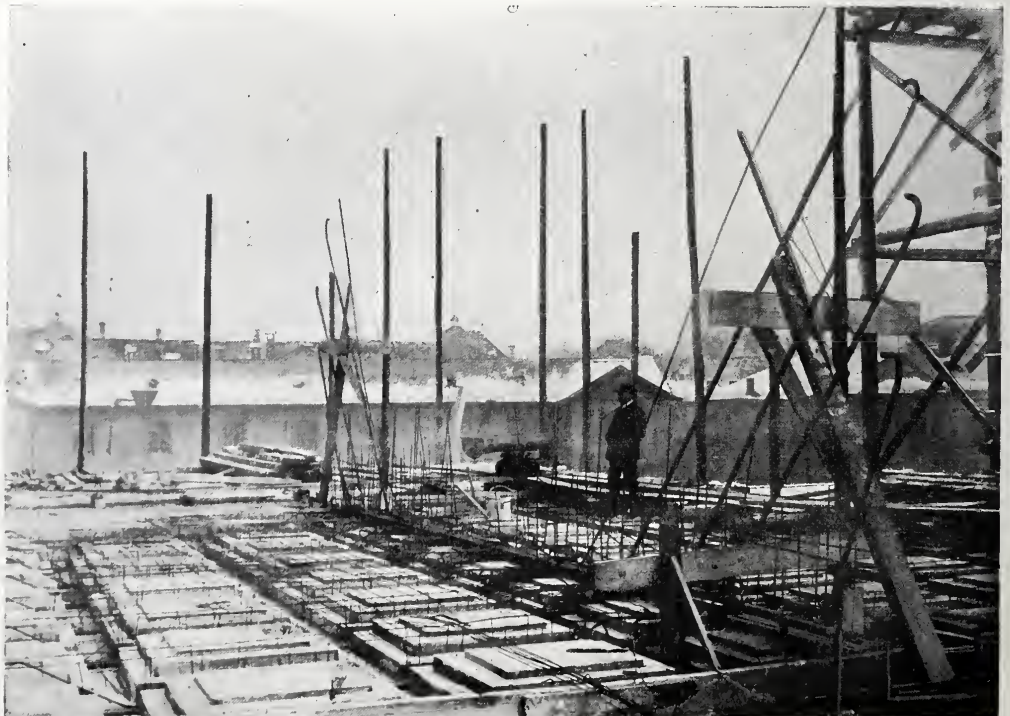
Schalung der Decke und Bewehrung der Wand über der Eingangshalle.
